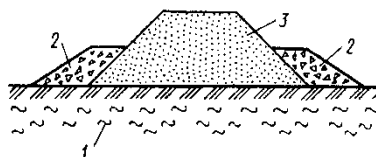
Увеличение устойчивости насыпи на слабых грунтах методом боковой пригрузки:
